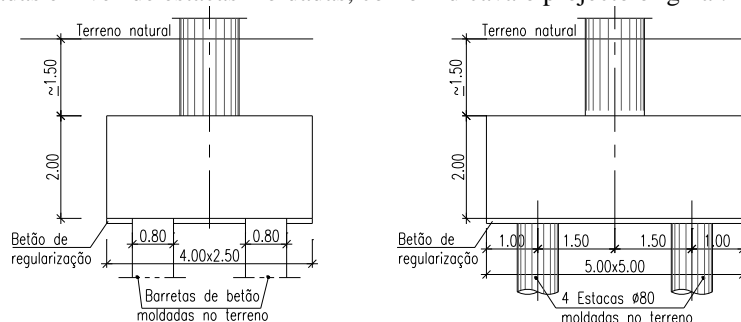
Maciços de fundação de barretas – 1ª fase; maciços de fundação de estacas – 2ª fase.
